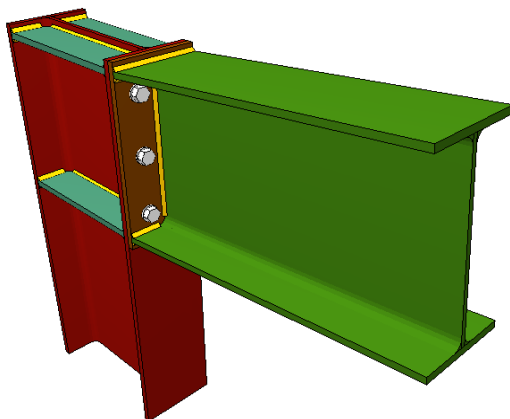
Unión rígida pilar de esquina-dintel pórtico fachada
